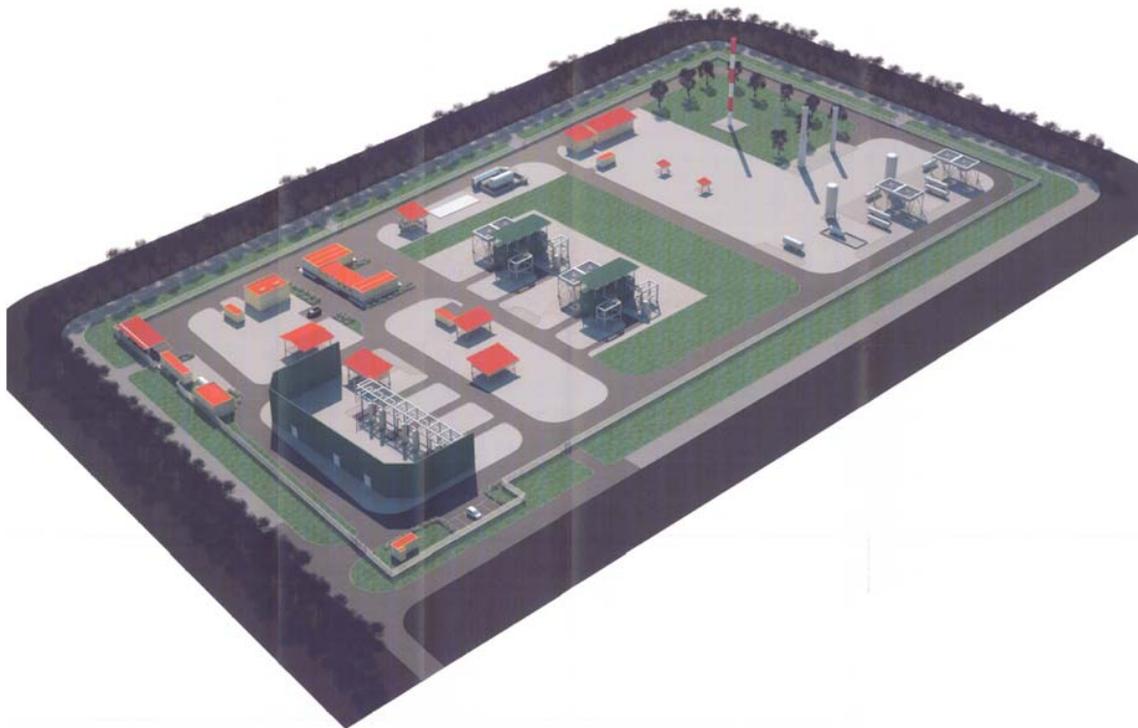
Rendering Prospettico, Centrale di Stoccaggio Gas – Fase 1
